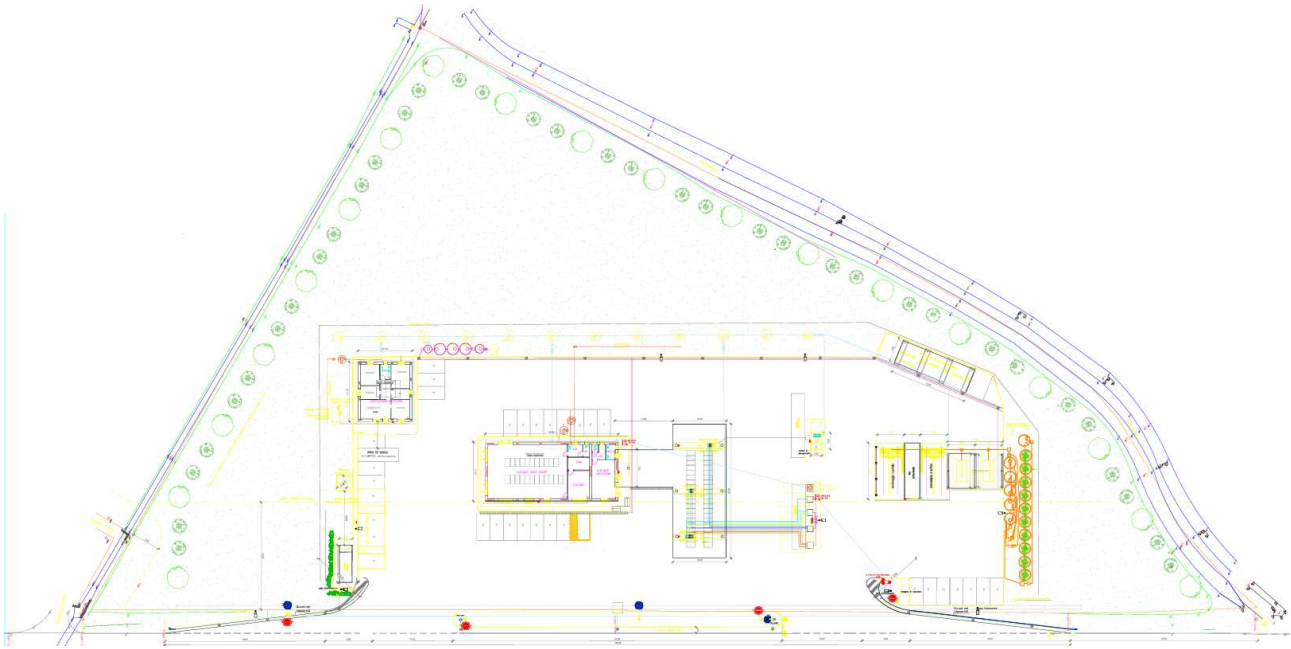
Estratto di progetto con evidenza del filare lungo il perimetro e la siepe a ridosso della struttura all'ingresso lato sud
